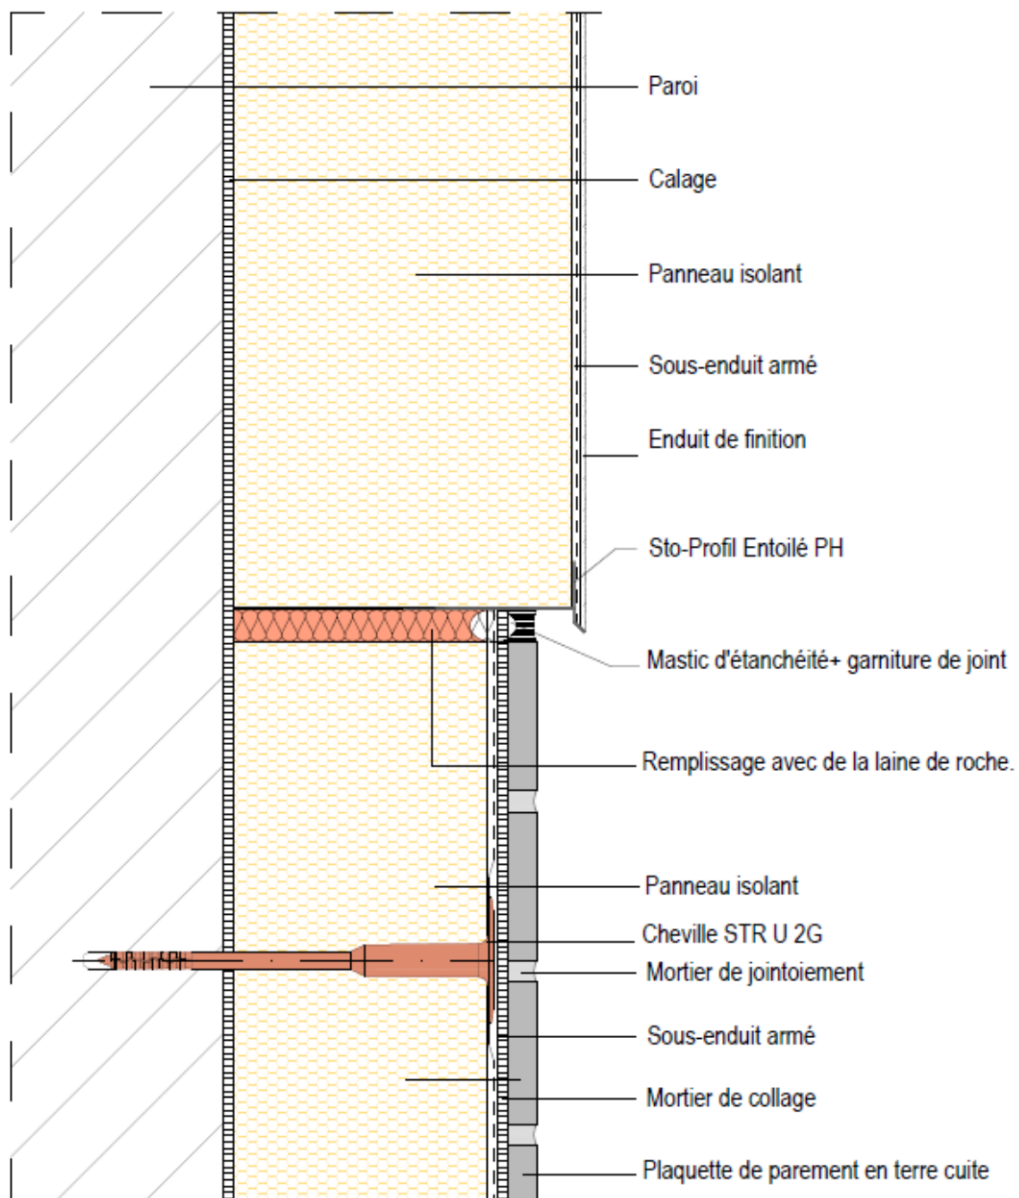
Raccordement entre finition par plaquette en terre cuite et finition par enduit – isolant continu
